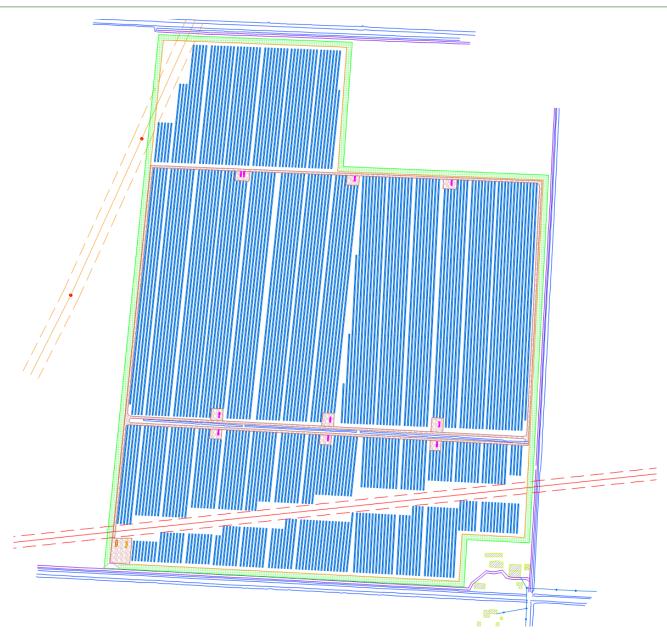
Configurazione sezione Ovest dell'impianto agrovoltaico
